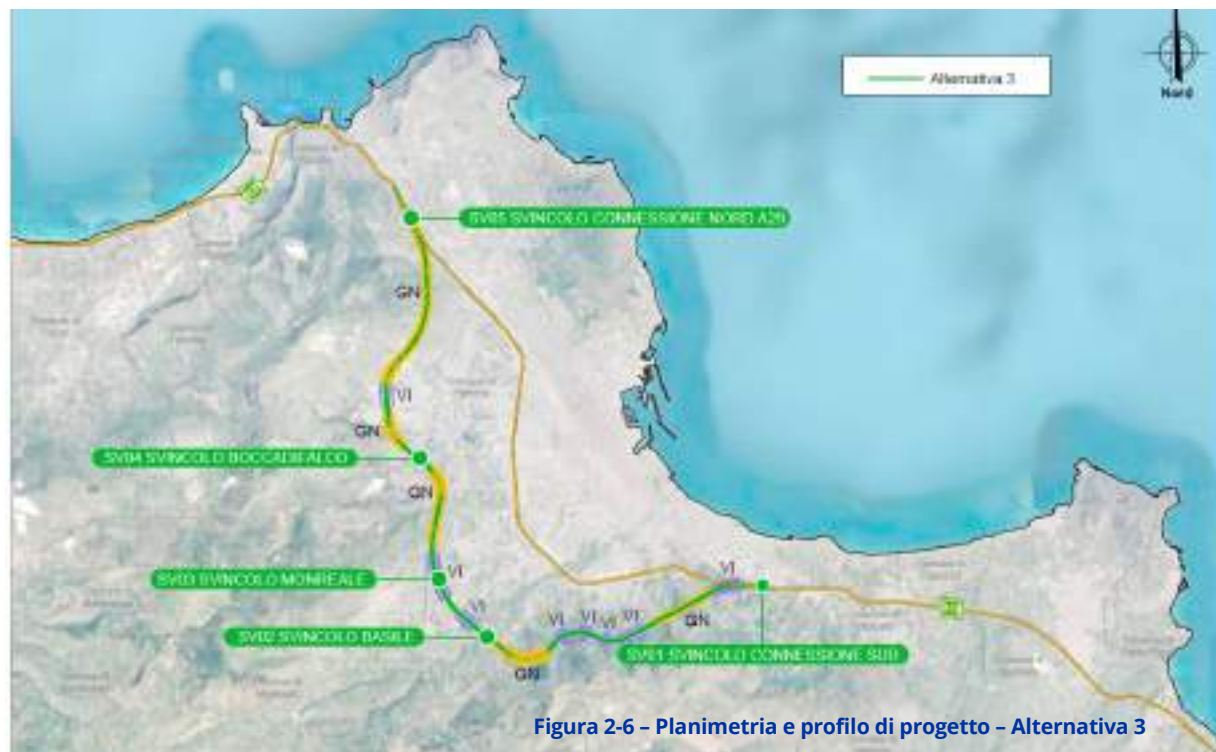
Planimetria e profilo di progetto - Alternativa 3
